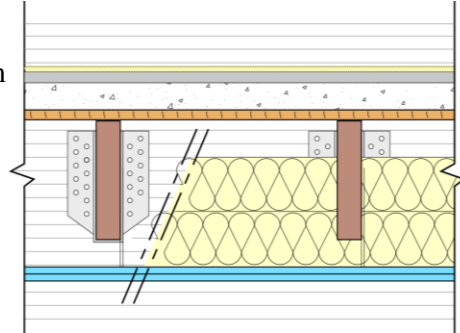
Montage Configuration 1 et essai de choc au ballon Japonais
